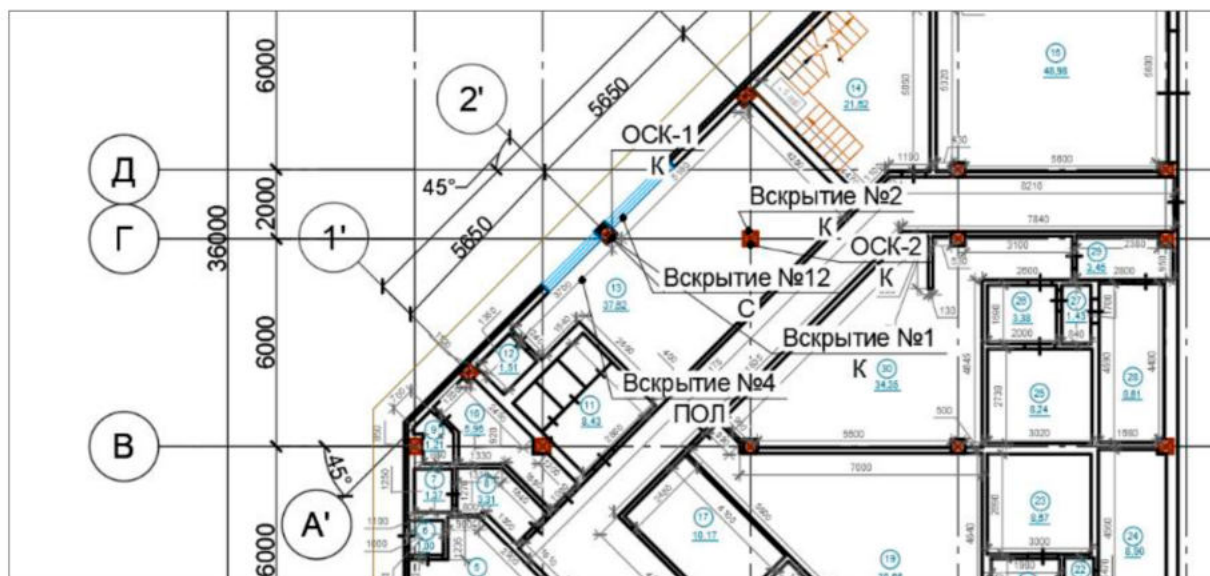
Фрагмент схемы расположения мест вскрытий строительных конструкций.
